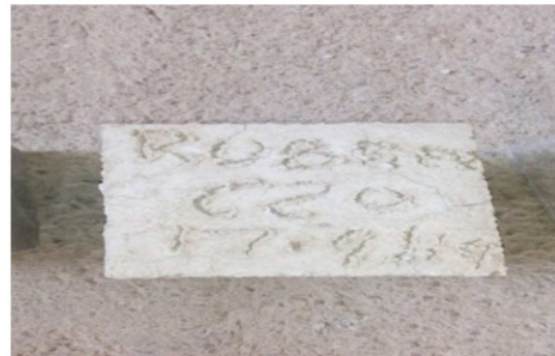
橡胶钢筋混凝土和普通混凝土在 100℃ 下加热 48 小时后出现一些裂缝。
